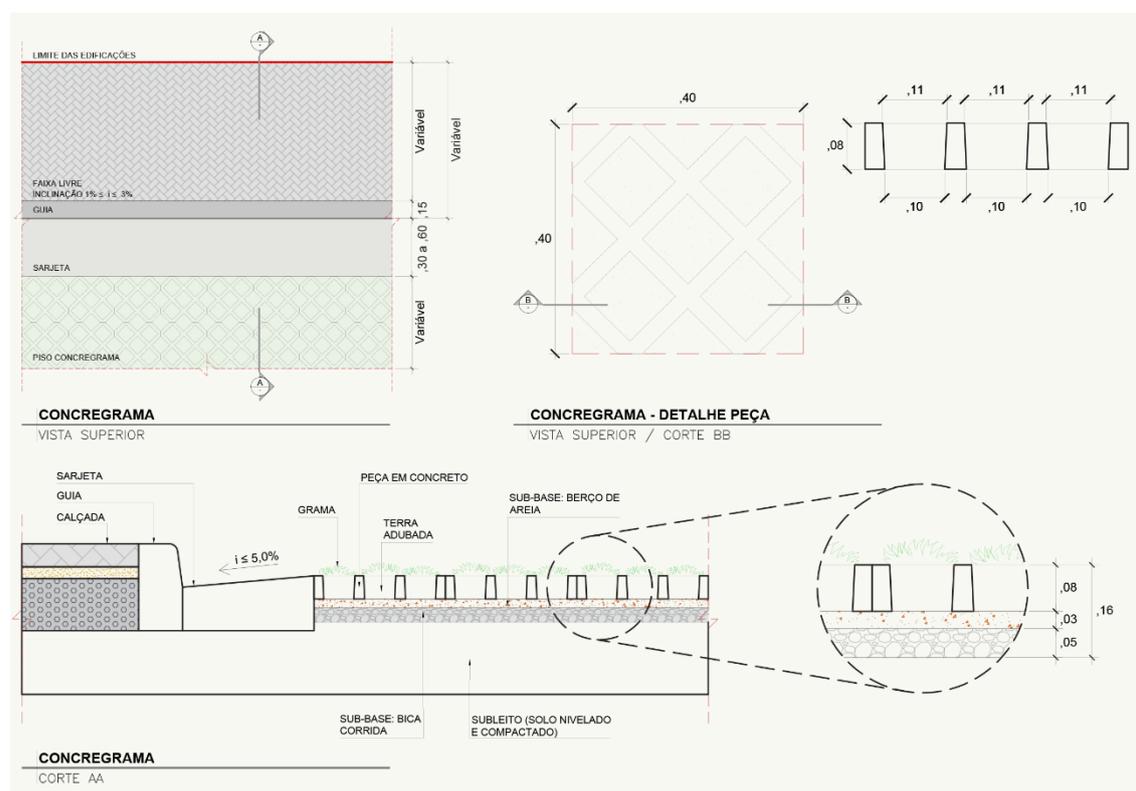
Detalhamento em planta, corte e detalhe da peça de concregrama. Fonte: São Paulo, 2024, p. 105, modificado pela autora.
